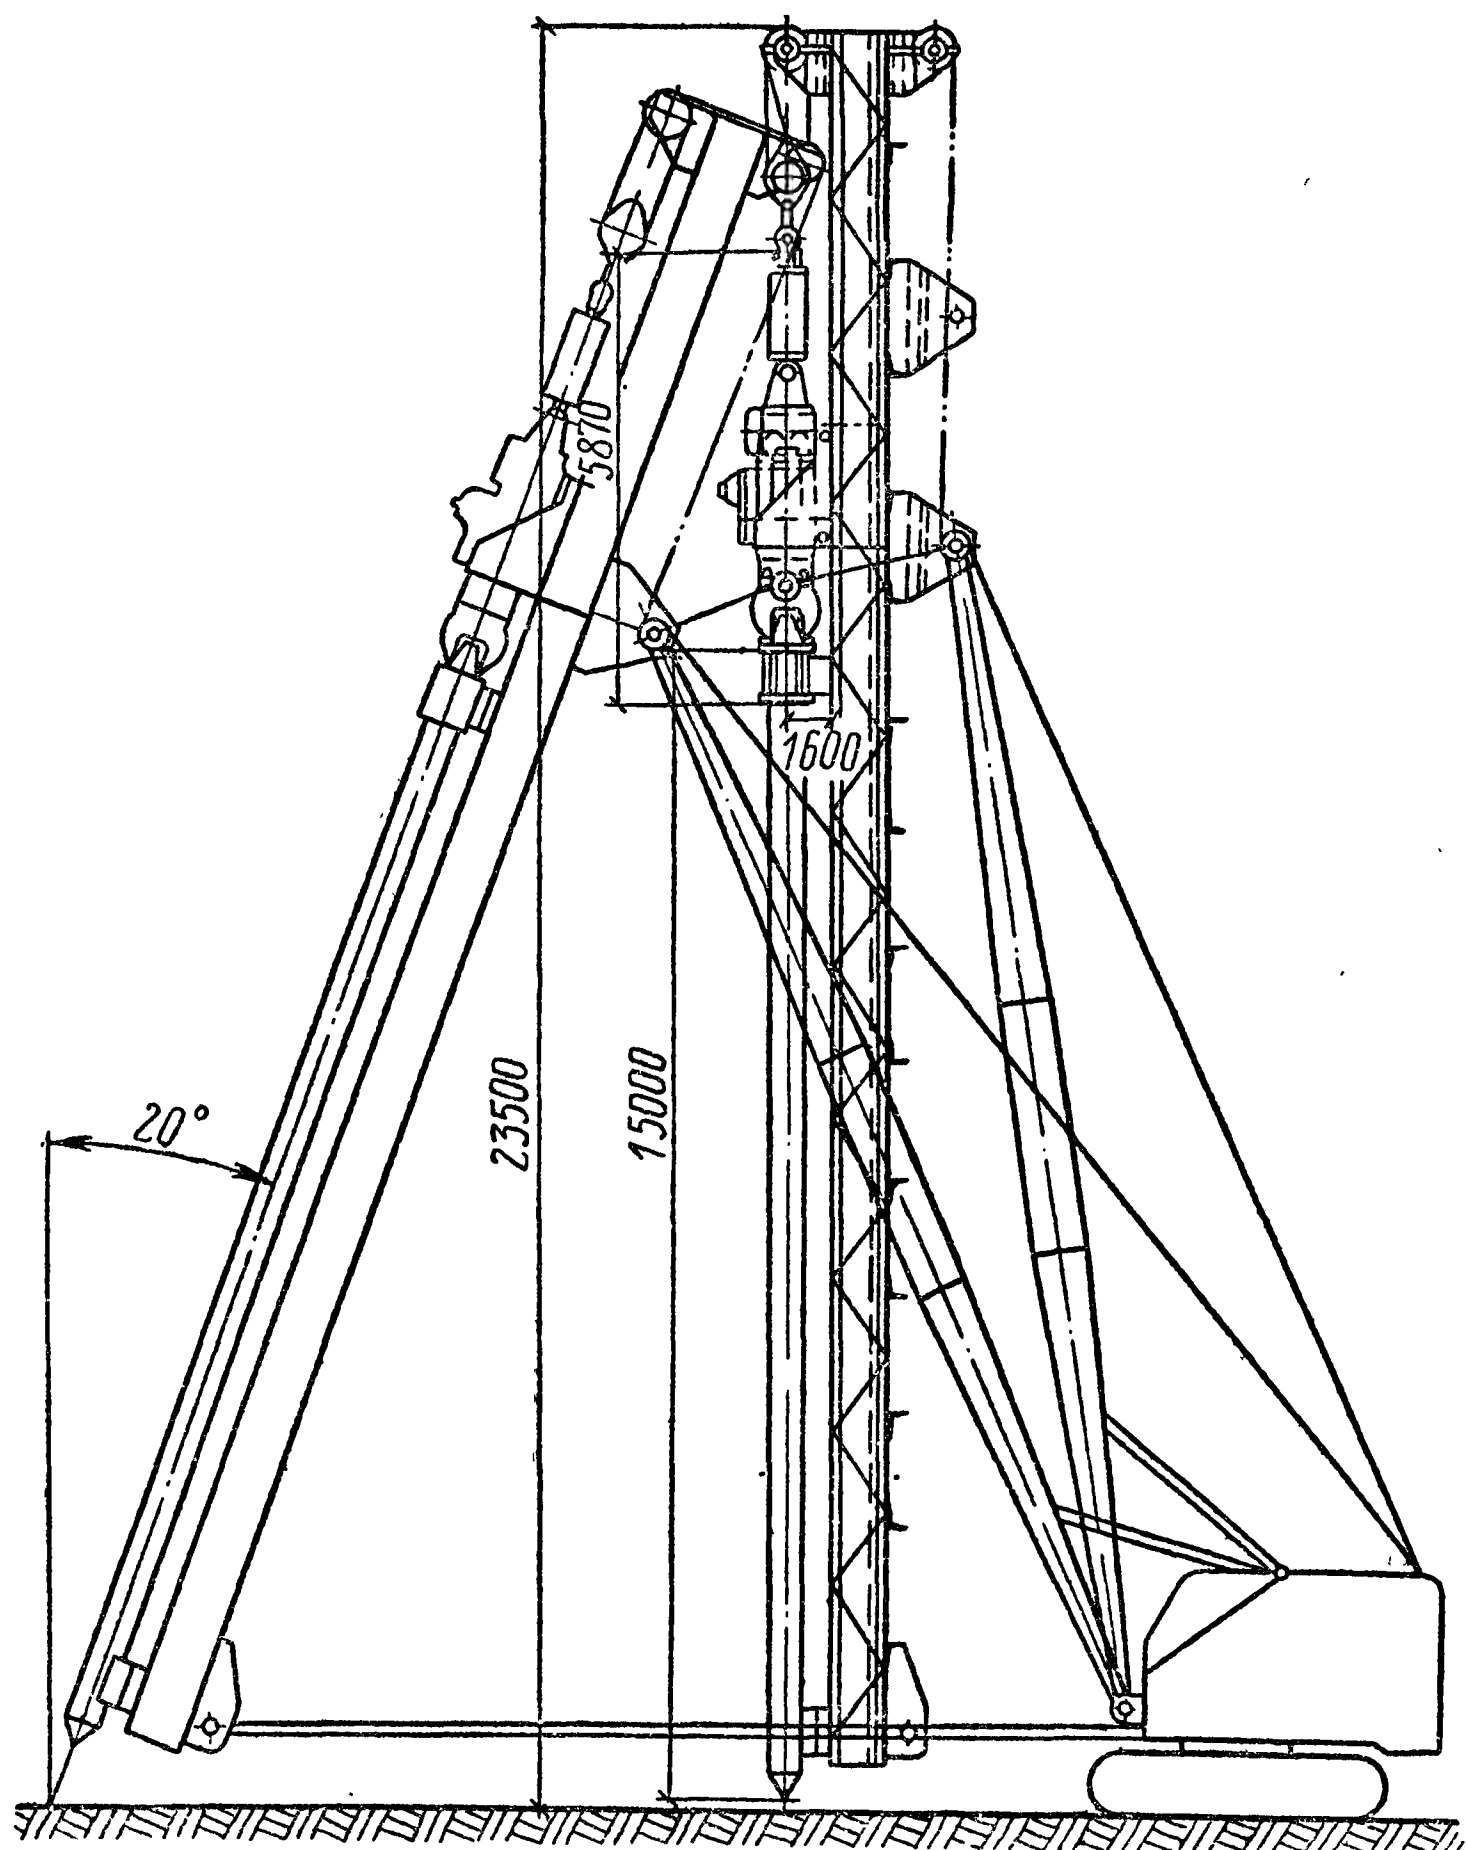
Гусеничный кран с подвесной стрелой для погружения свай-оболочек
